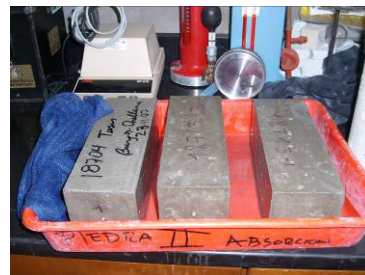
Viguitas en ambiente seco y ventilación constante
